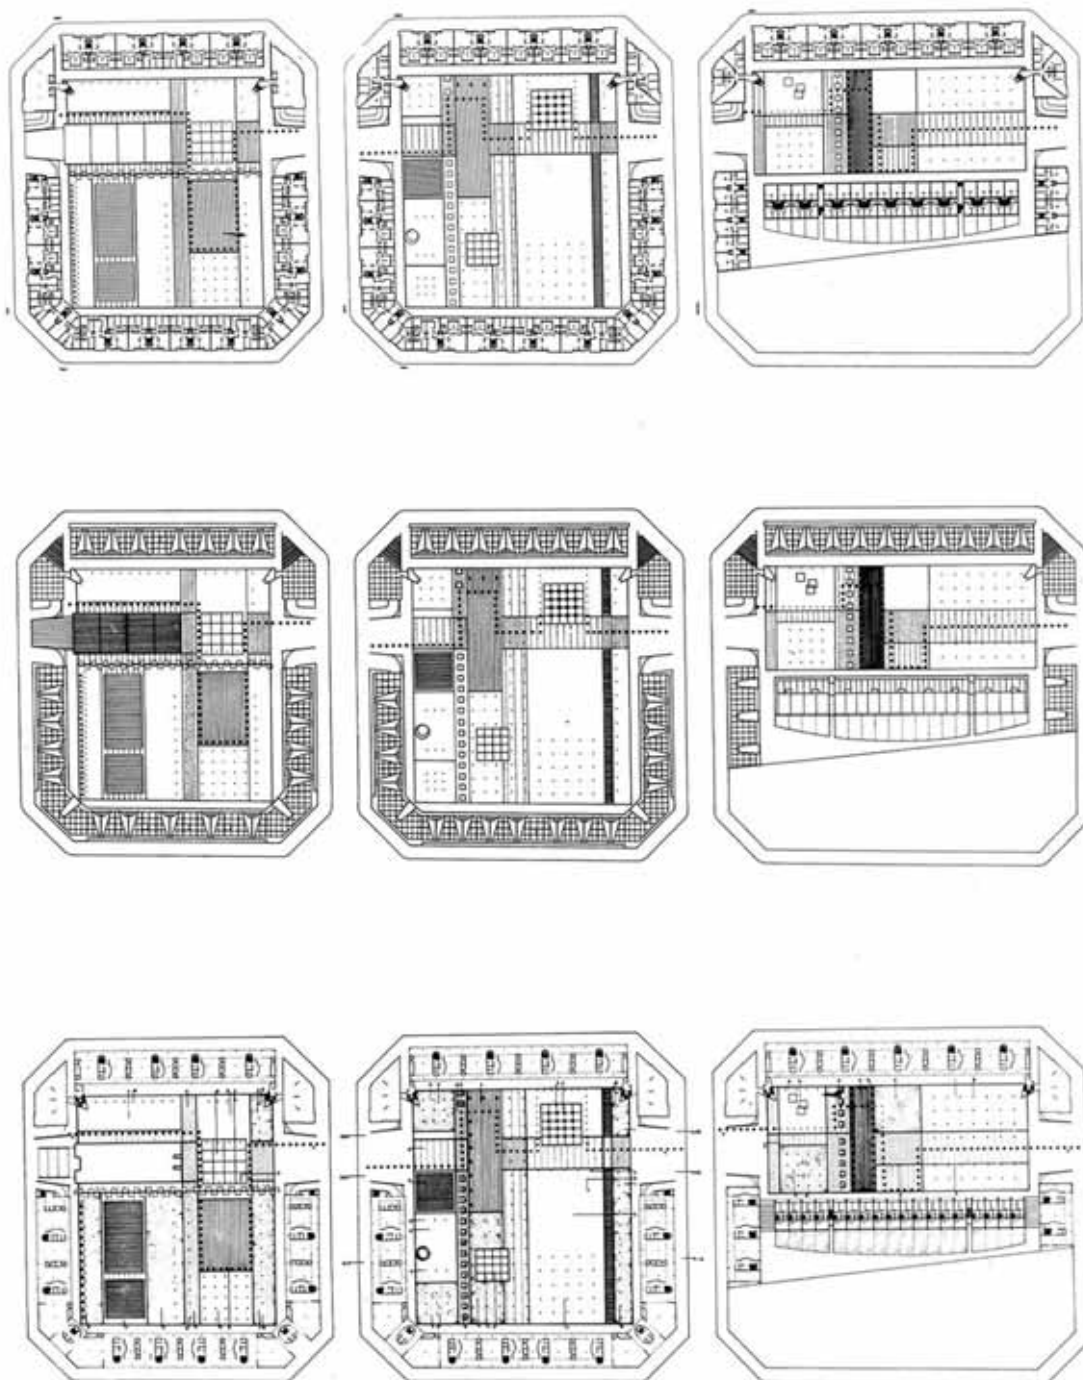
Plantas - Três manzanas de Carlos Ferrater
